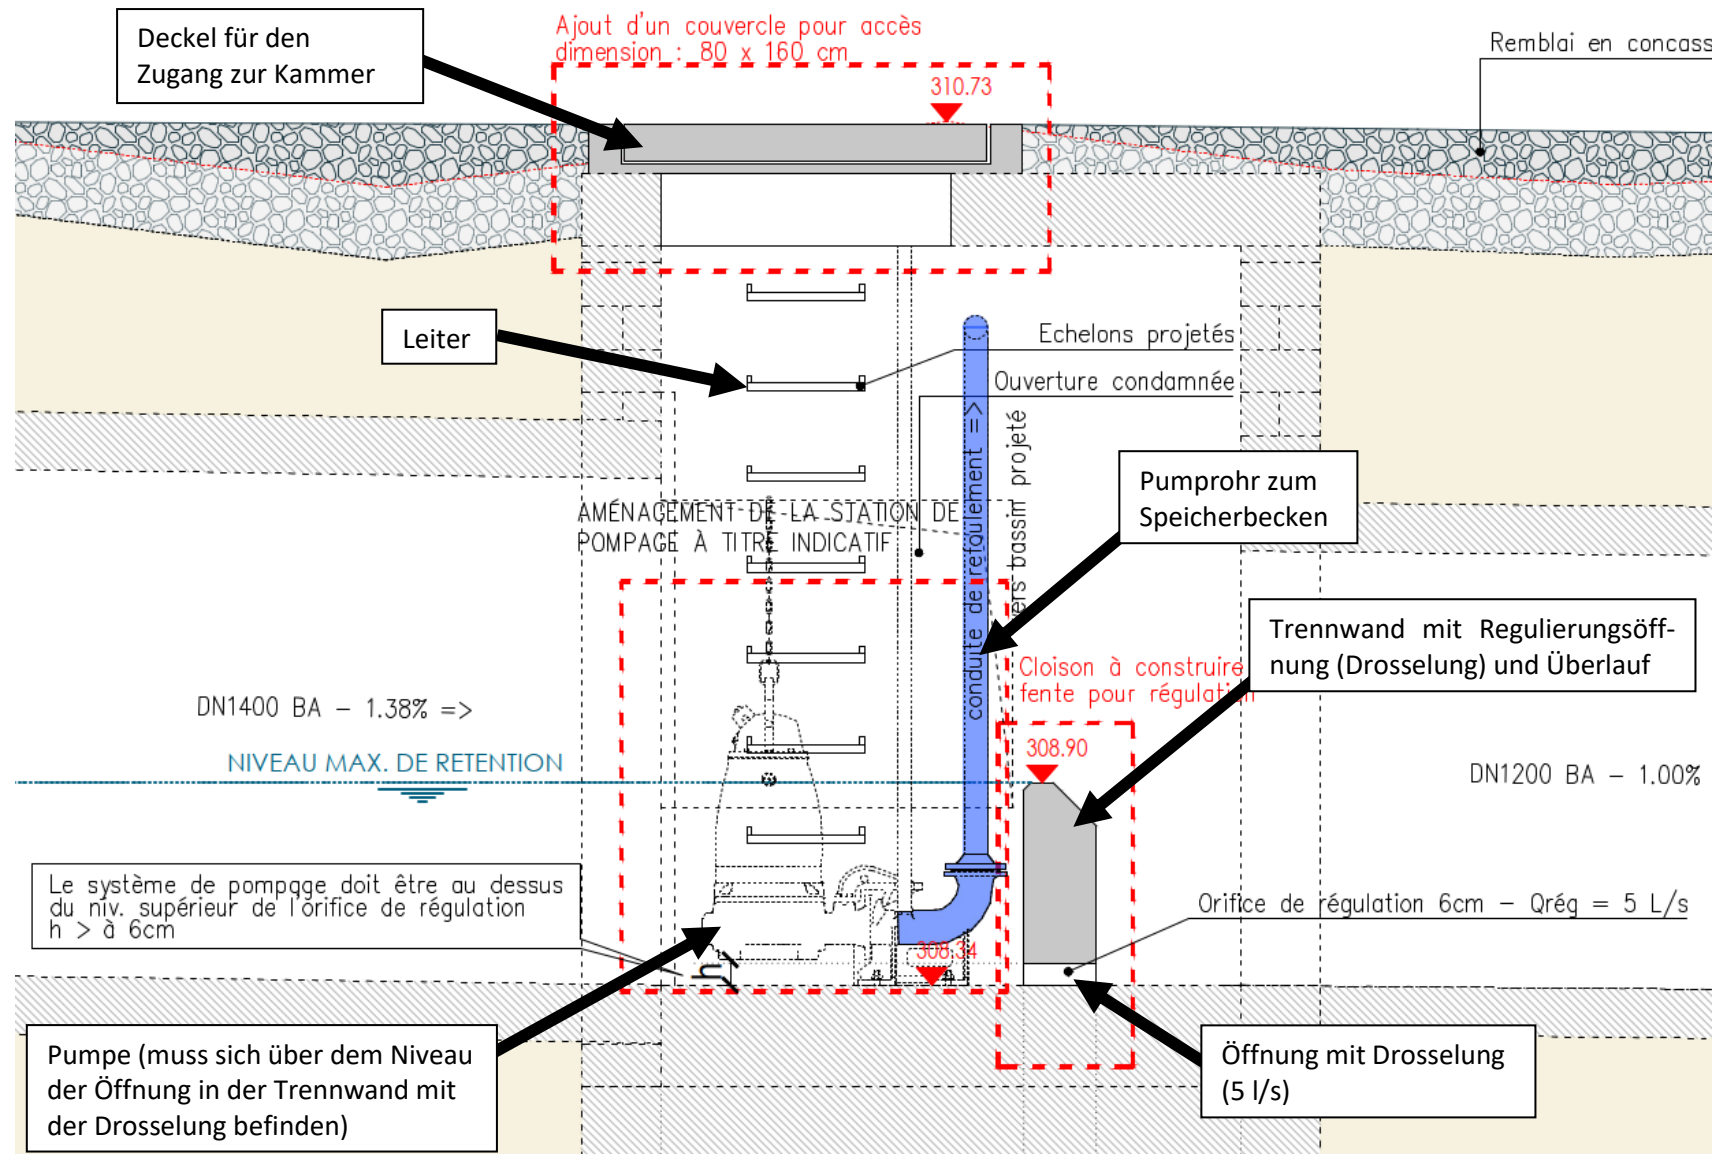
Auszug aus dem Plan „Concept du Bassin – Déplacement du Ruisseau – Coupes Projetées“: Nahansicht der Pumpkammer (Luxplan S.A. 02/2024).
